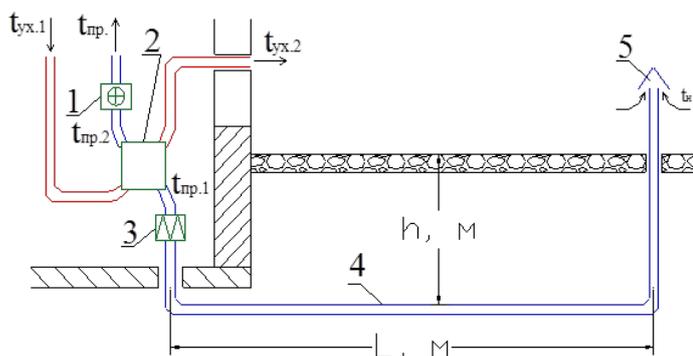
Принципиальная схема вентиляции здания с утилизацией теплоты грунта и вытяжного воздуха
